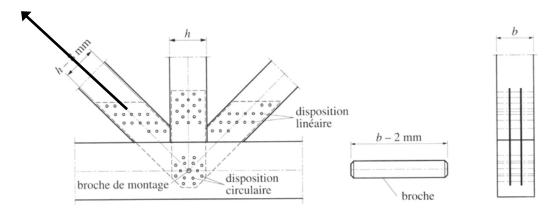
Assemblage d'une poutre triangulée avec le système BSB.
